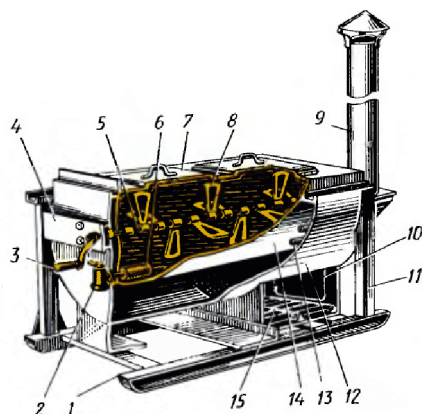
Битумоварочный котел конструкции Союзспецстрой: 1 — сварочная рама; 2 — сливной кран, 3 — рукоятка, 4 — коробка передач, 5 — вал, 6 — сетчатый цилиндр сливного крана, 7 — крышка, 8 — лопасть мешалки, 9 — дымовая труба, 10 — топка, 11 — опорная стойка, 12 — наружная обшивка, 13 — газозовые трубки, 14 — внутренняя емкость, 15 — колосниковая решетка
